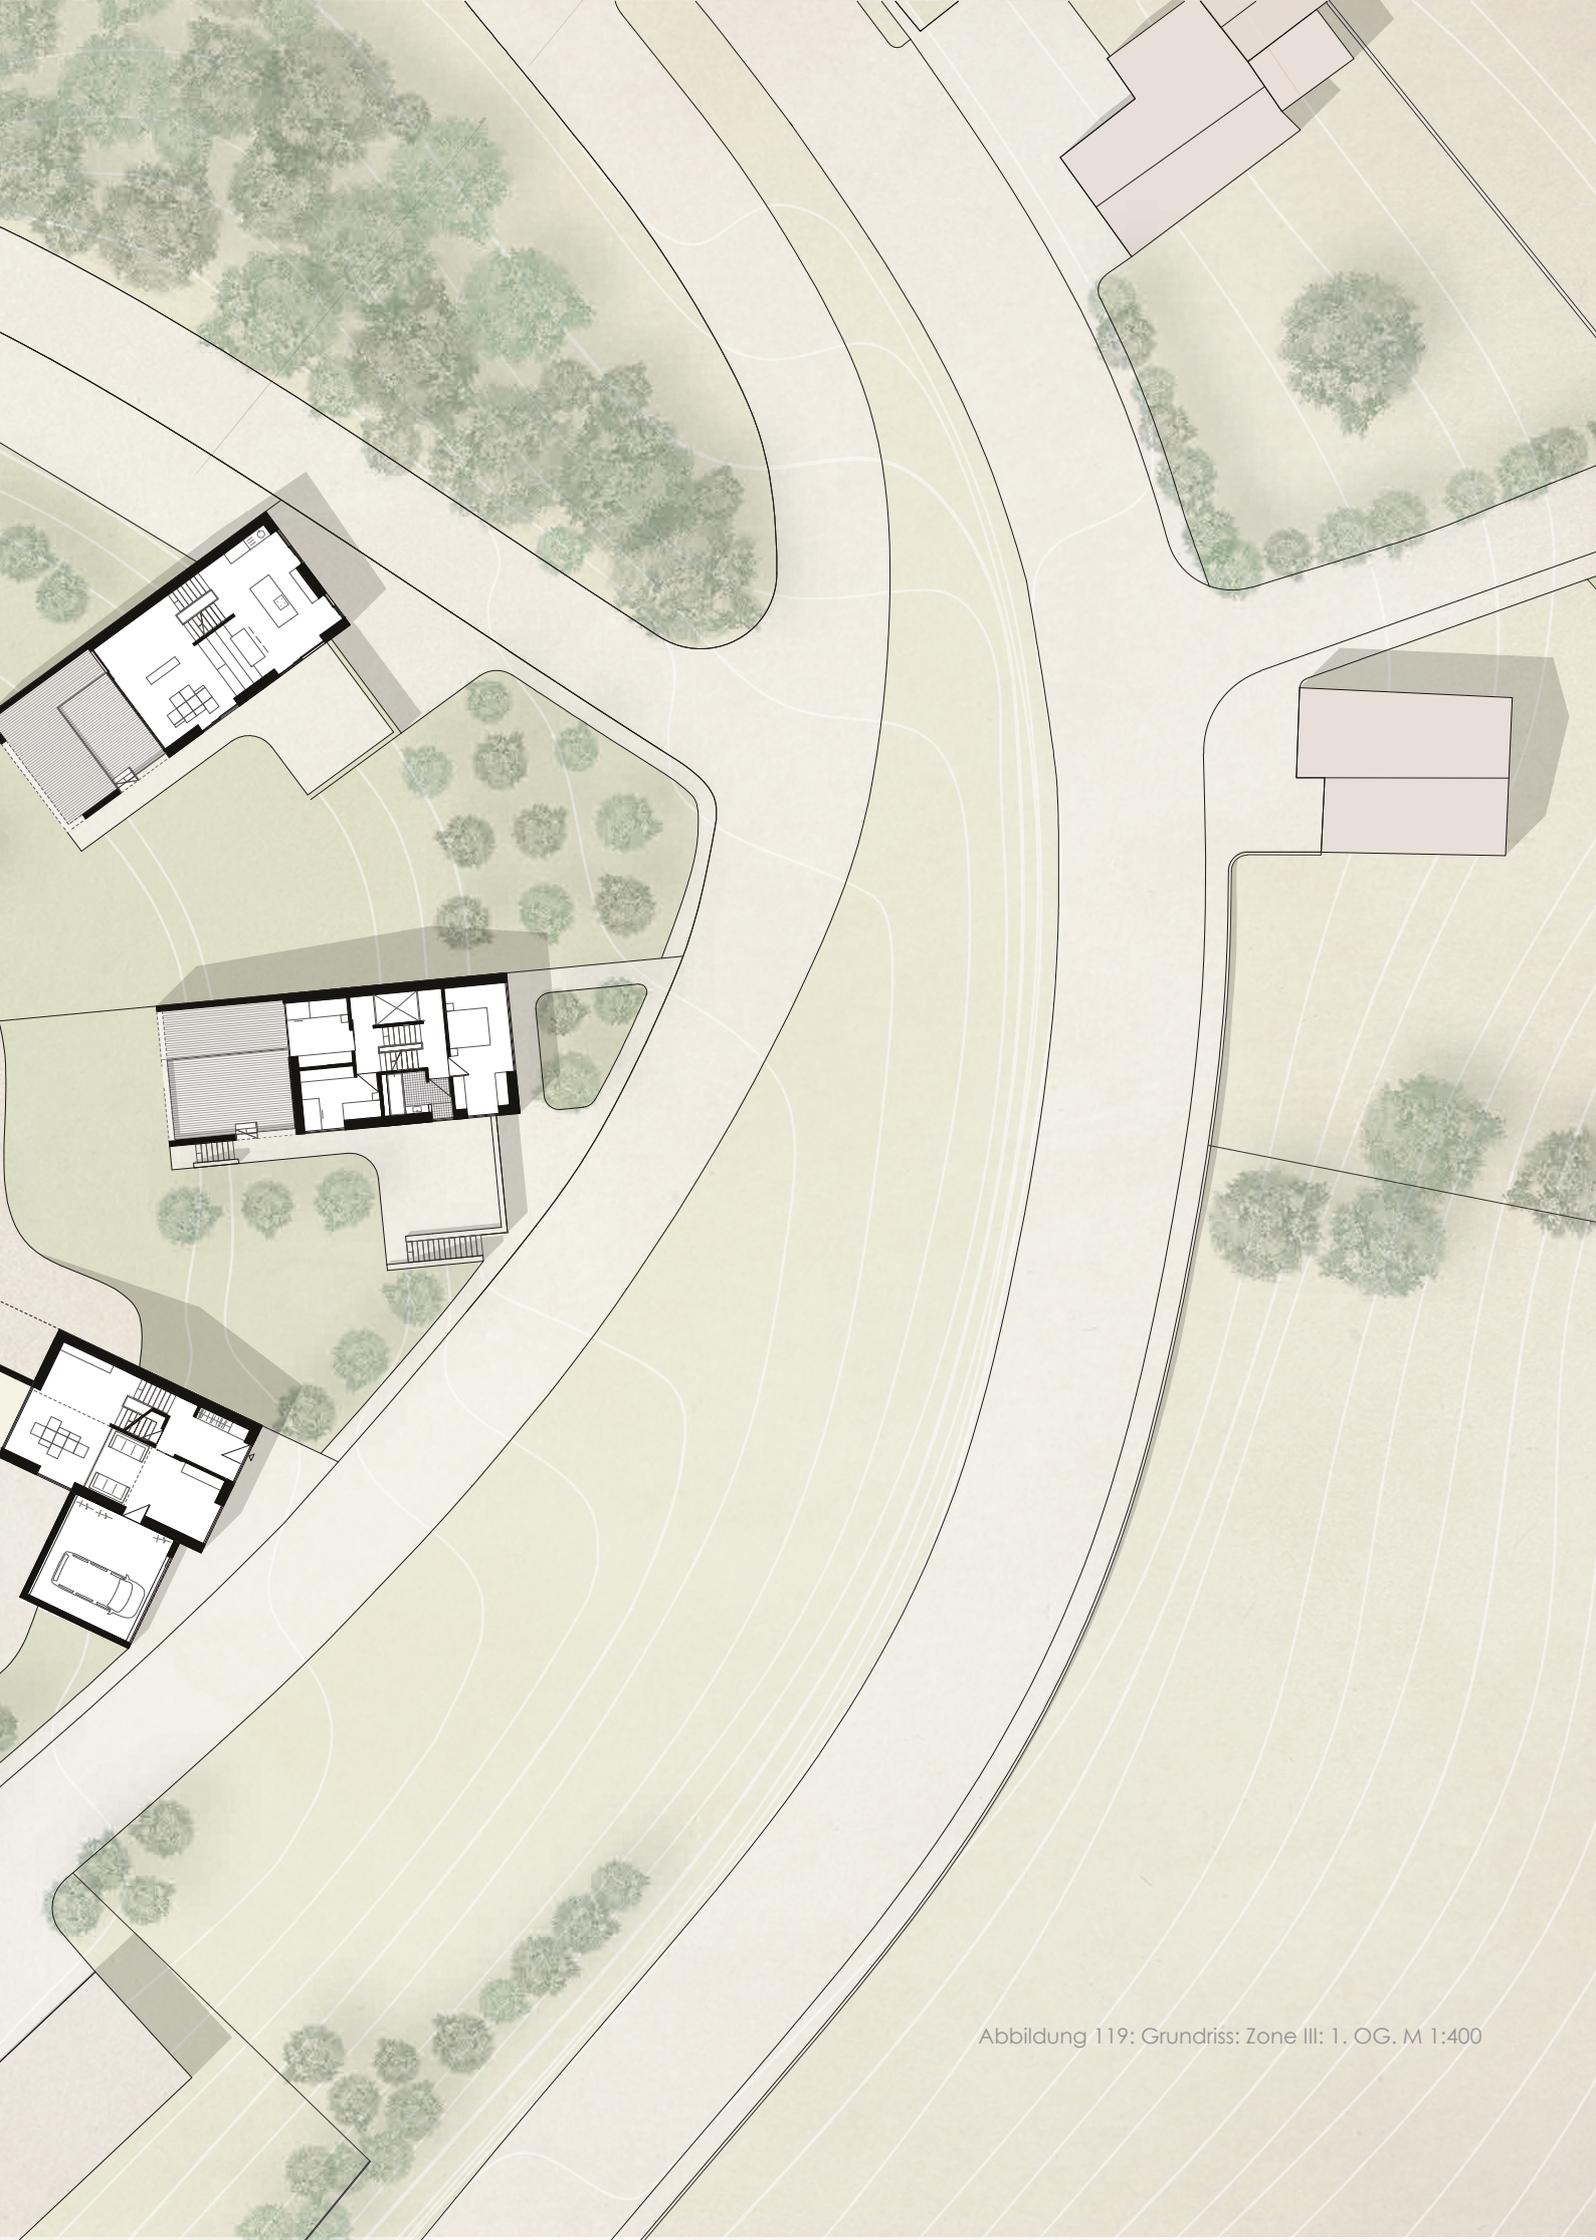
Grundriss: Zone III: 1. OG. M 1:400
